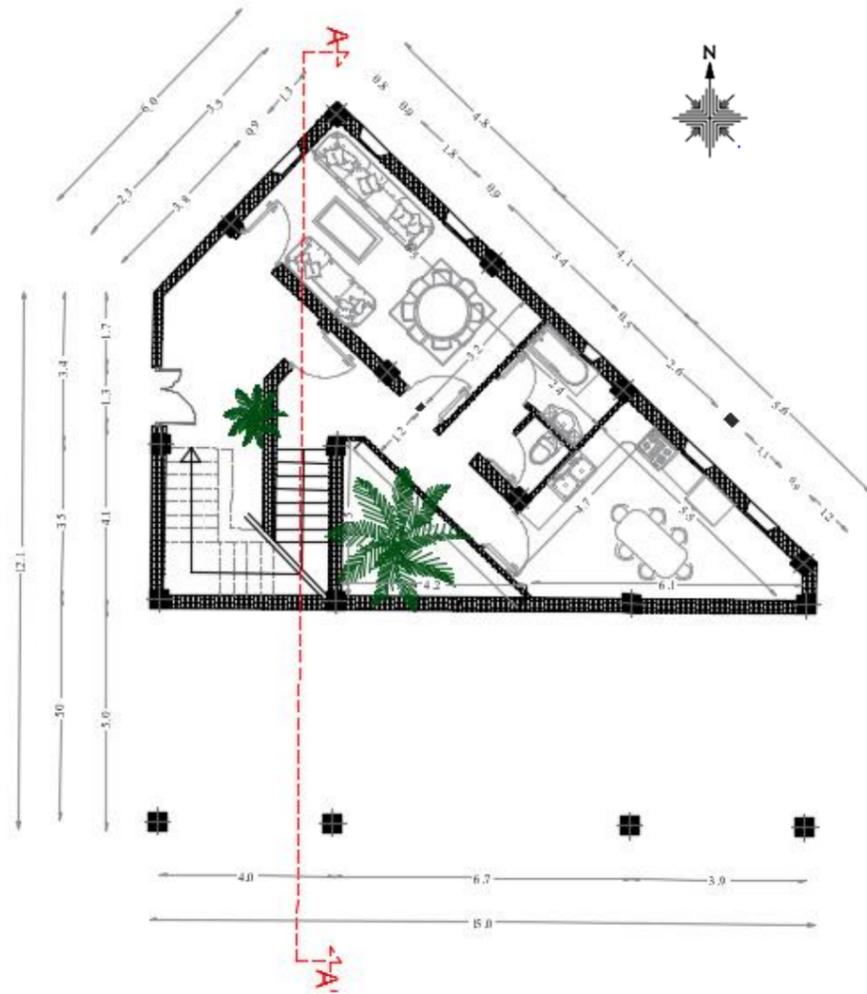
PLAN RDC LOGEMENT TYPE 5.
